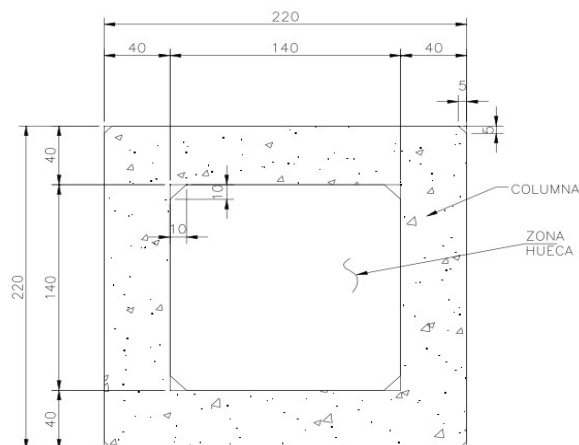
Geometría inferior de la columna (Fuente: especificaciones generales del proyecto)
